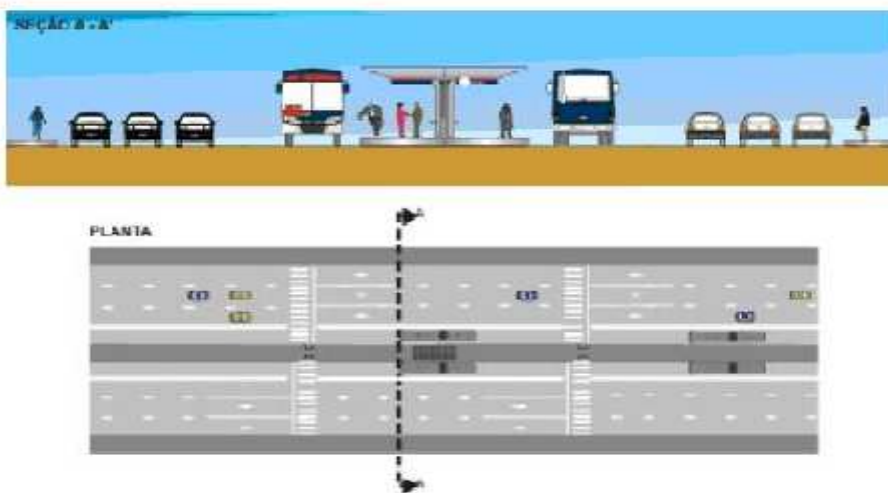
Faixa junto ao canteiro central com plataforma no canteiro central
